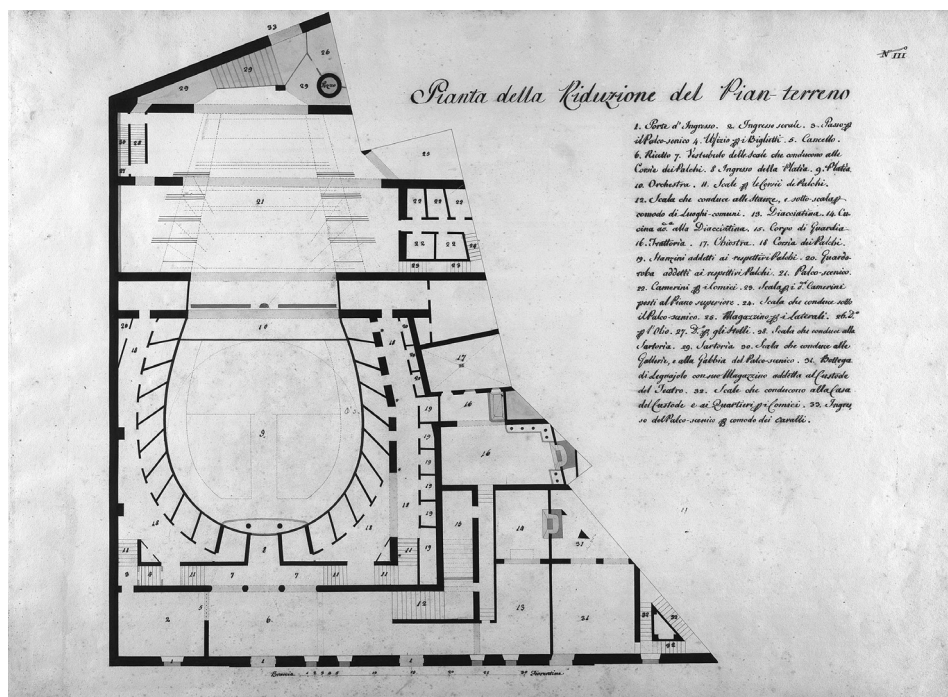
Album riduzione teatro dei Costanti a Pisa, pianta* (Proprietà Fondazione Pisa).
